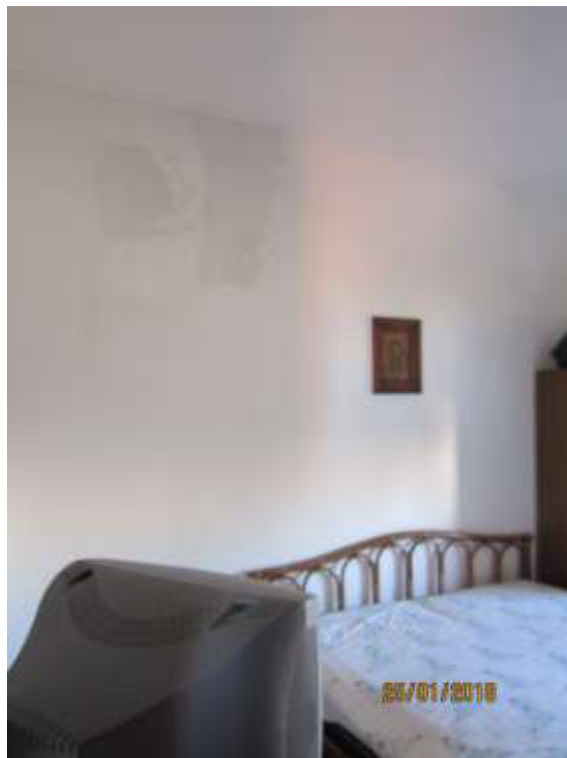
La camera da letto, in evidenza zona di umido alla parete
